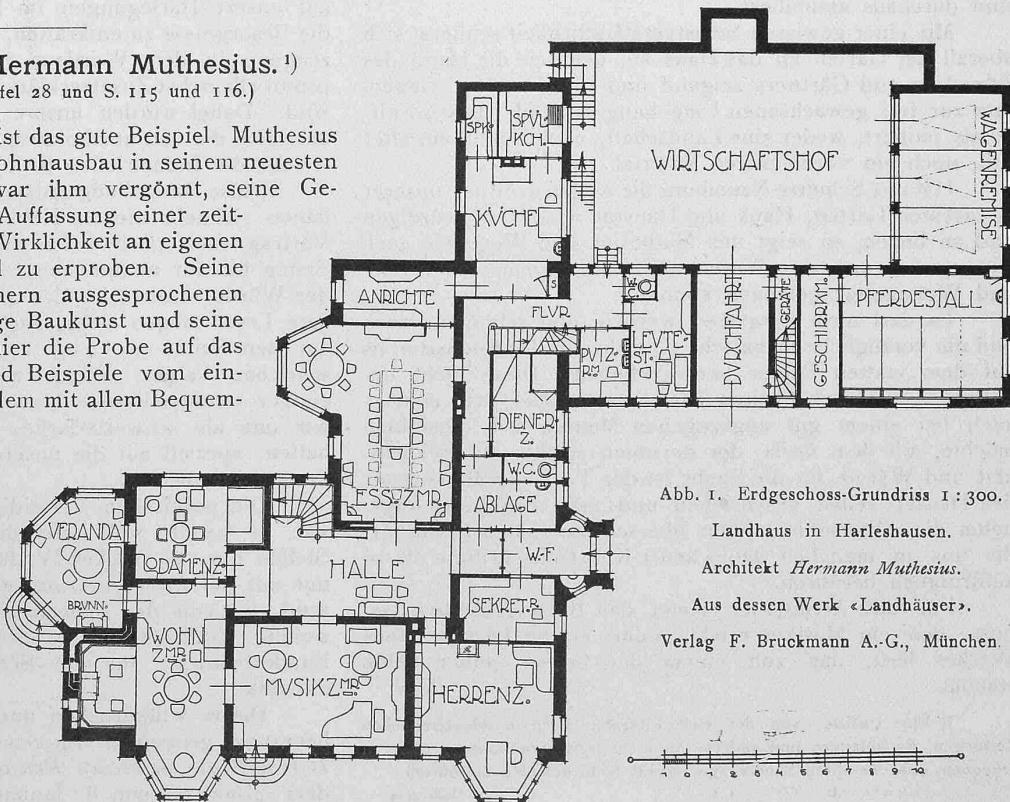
Erdgeschoss-Grundriss 1 : 300.
